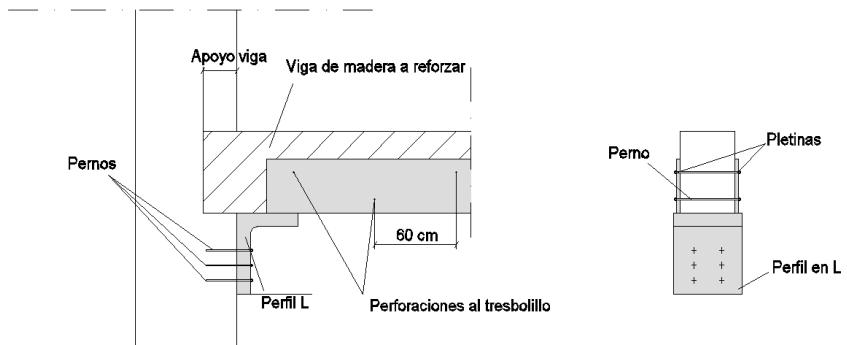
Detalle refuerzo viga cubierta. Fuente: Propia
